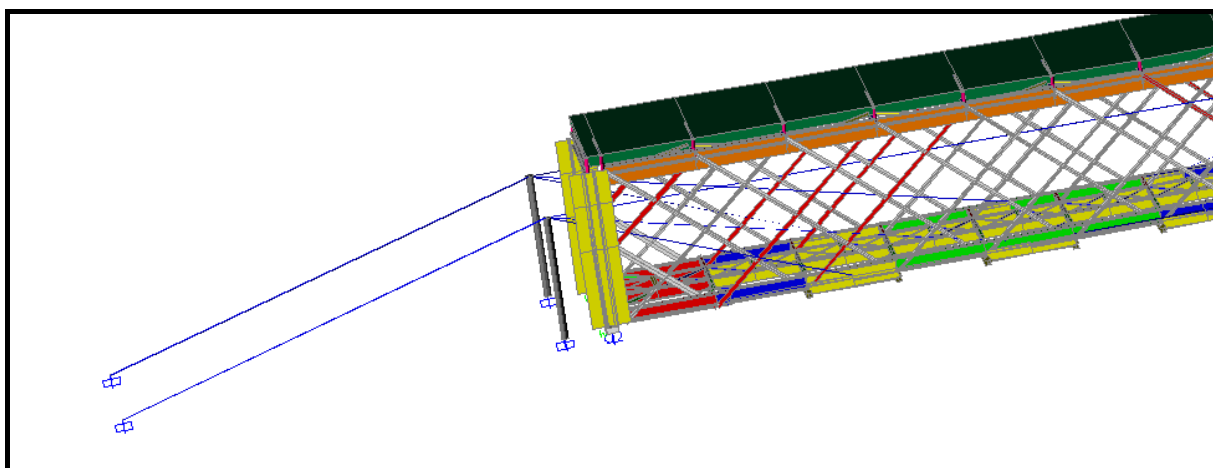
Pormenor da ligação dos cabos de pré-esforço ao exterior
